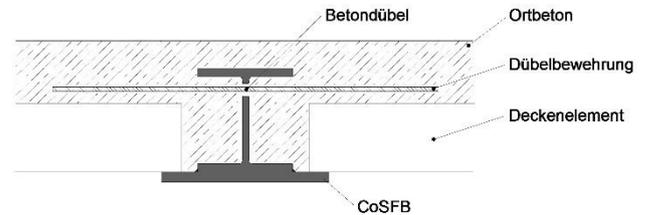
Slim-Floor Träger in Verbundbauweise mit CoSFB-Betondübel (CoSFB)
